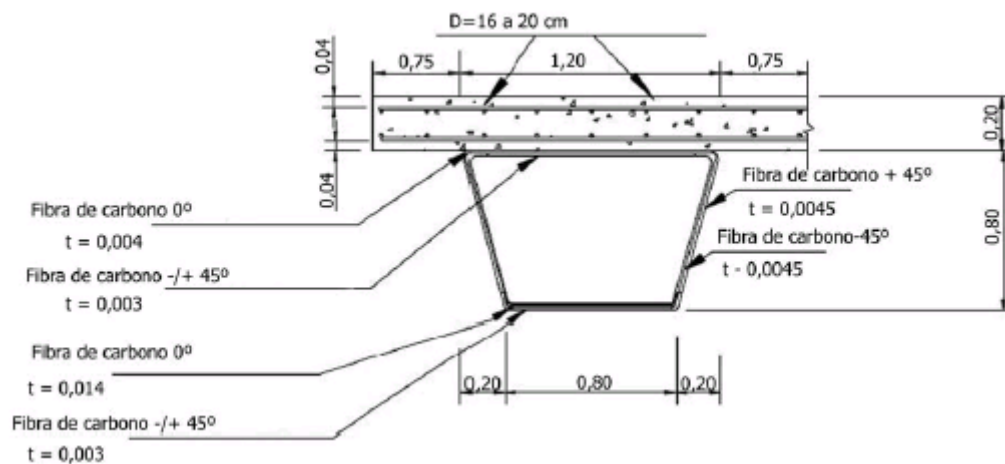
Puente construido por Acciona en España con vigas con FRP
